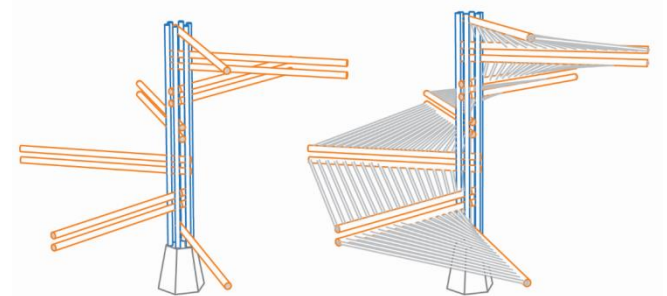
Perspectiva de la estructura principal con los elementos de cobertura
